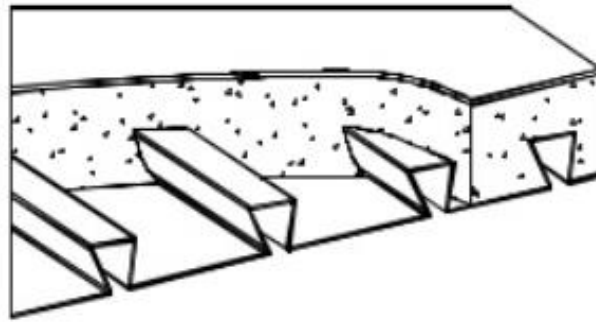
Detalhe de uma laje mista após a cura do concreto
